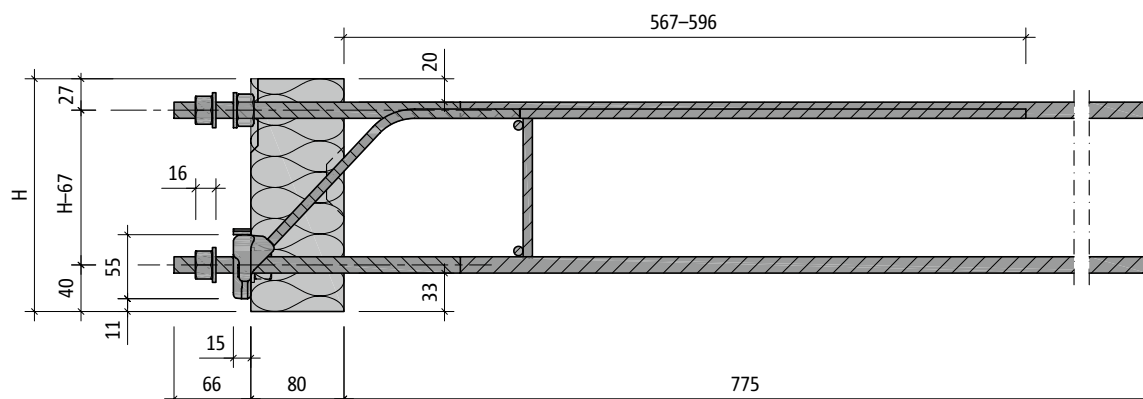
Schöck Isokorb® T type SK-MM1-VV1 : vue en coupe du produit
